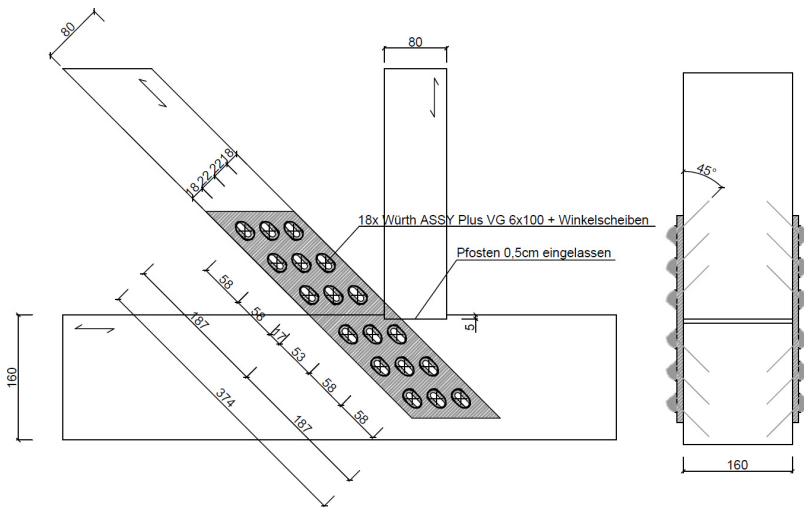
Knotendetail Träger VG-2, Maße in mm (Trägerbreite B = 160 mm).
